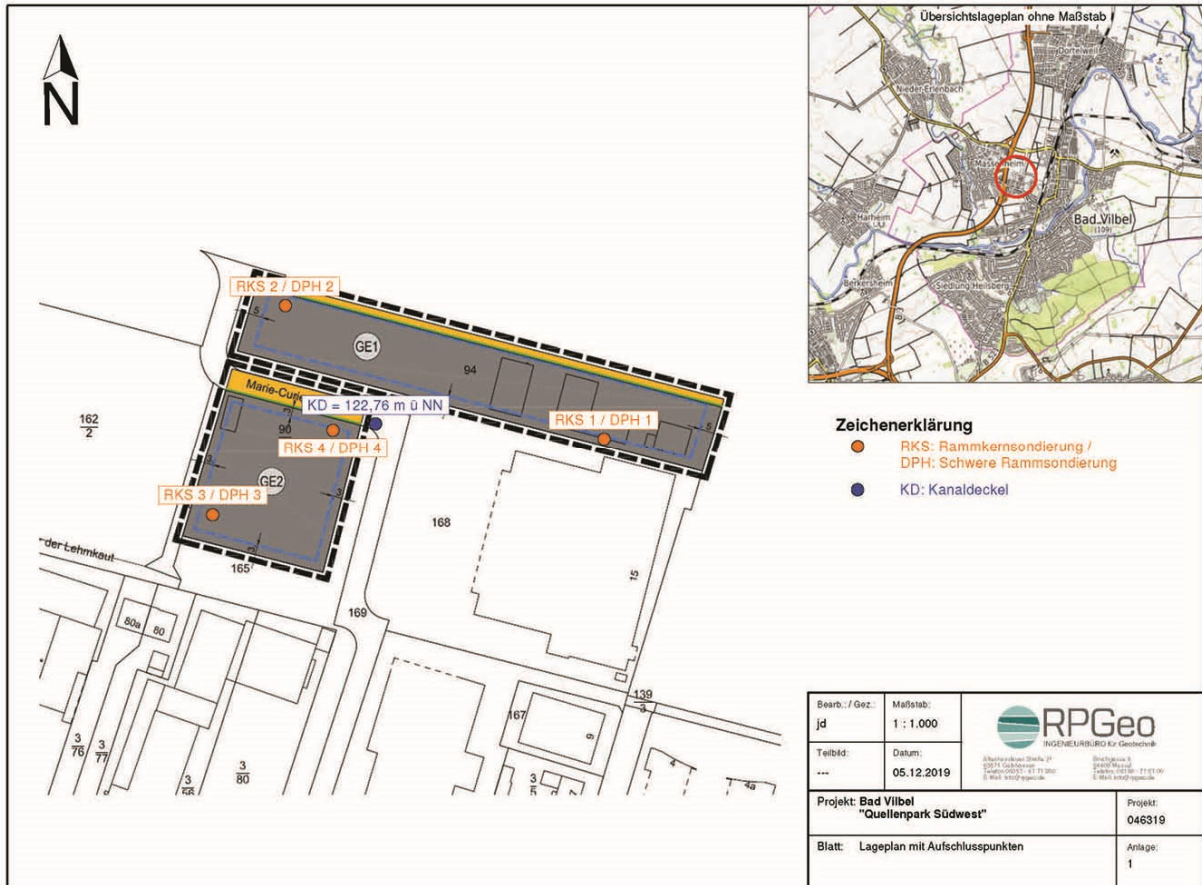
Lageplan mit Aufschlusspunktenⁱ
